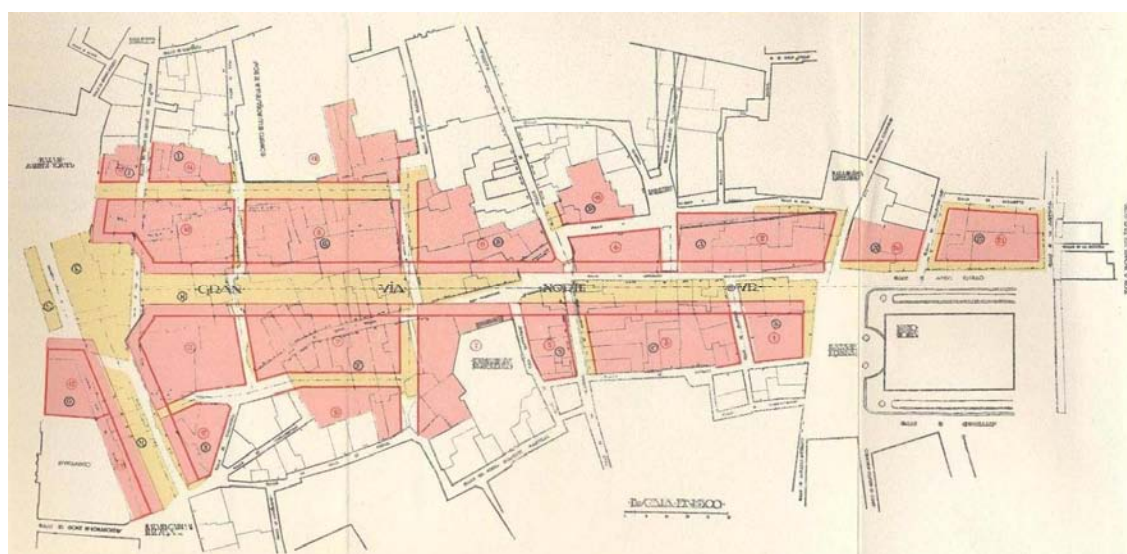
12. MURCIA. Plano general de la gran vía Norte-Sur proyectada por César Cort (1932).
